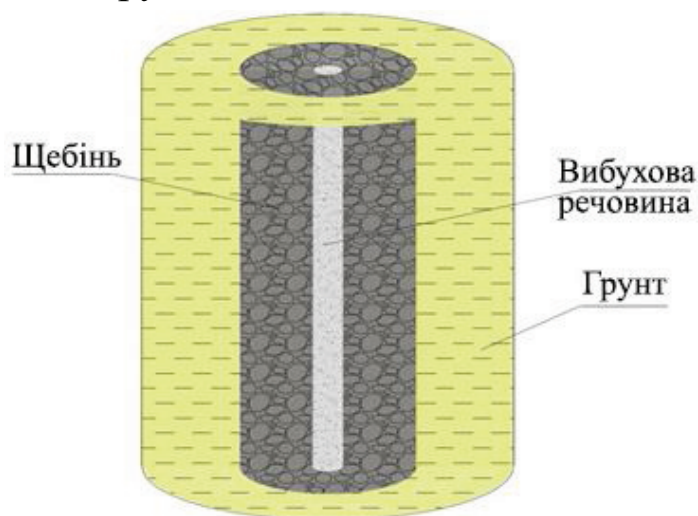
Комбінована схема розташування циліндричного заряду хімічної вибухової речовини
